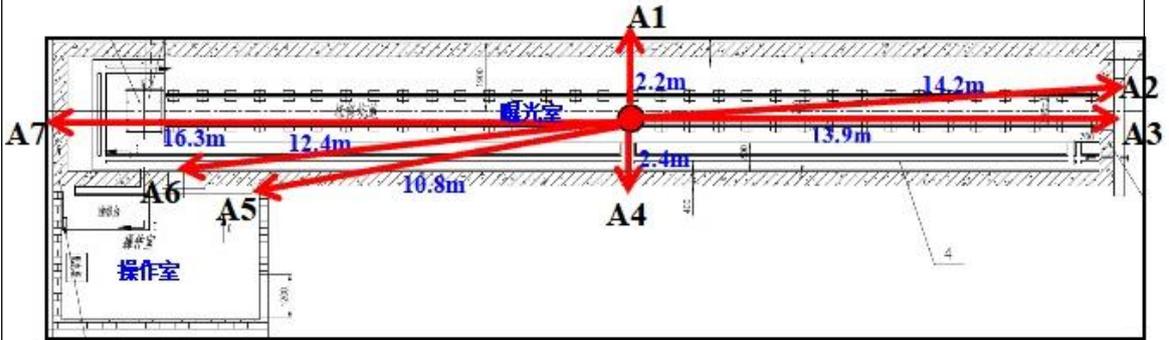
3#探伤室射线源到周围屏蔽体距离图（平面图）
